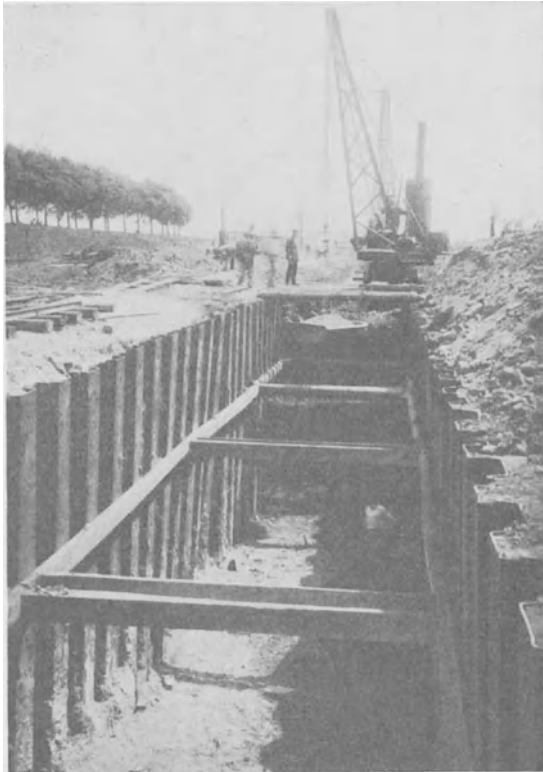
Baugrubenaussteifung mit eisernen Spundwänden.
